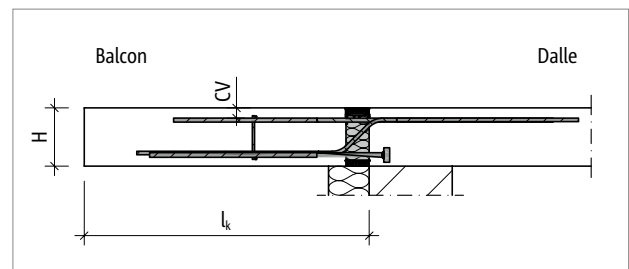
Schöck Isokorb® T type K-T-M13 : système statique
